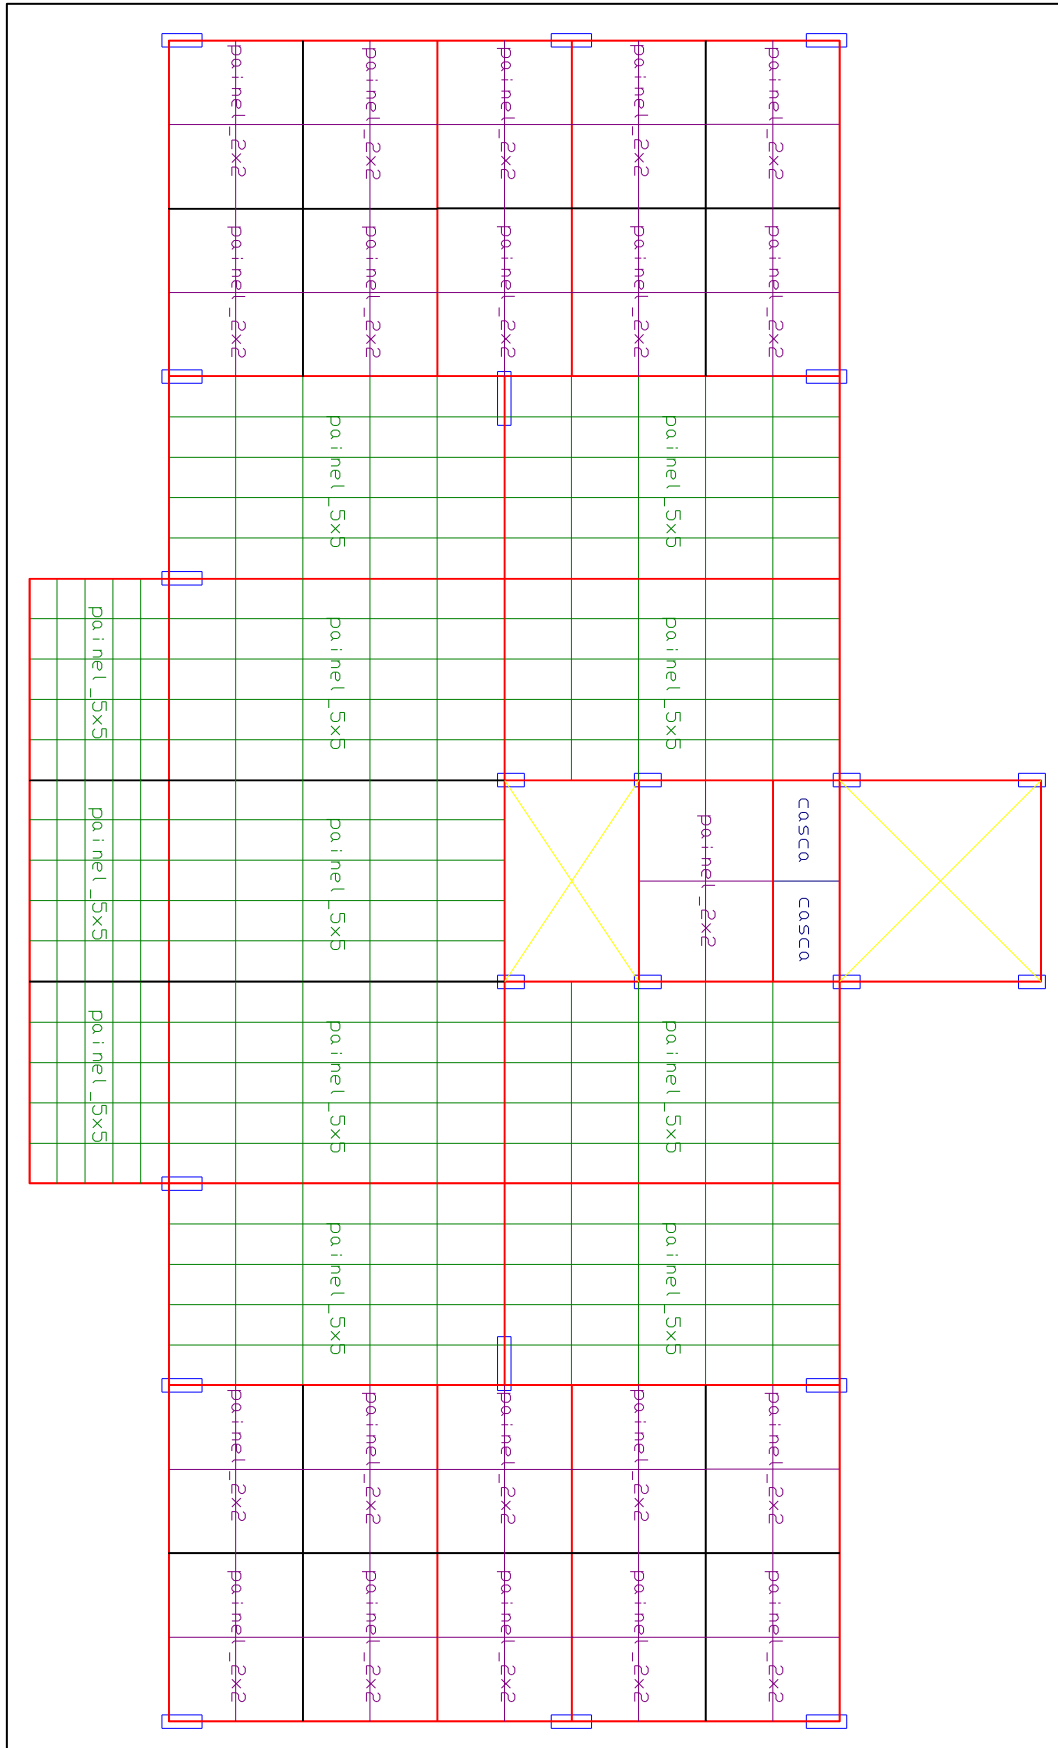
malha de elementos finitos do pavimento tipo – exemplo 2
